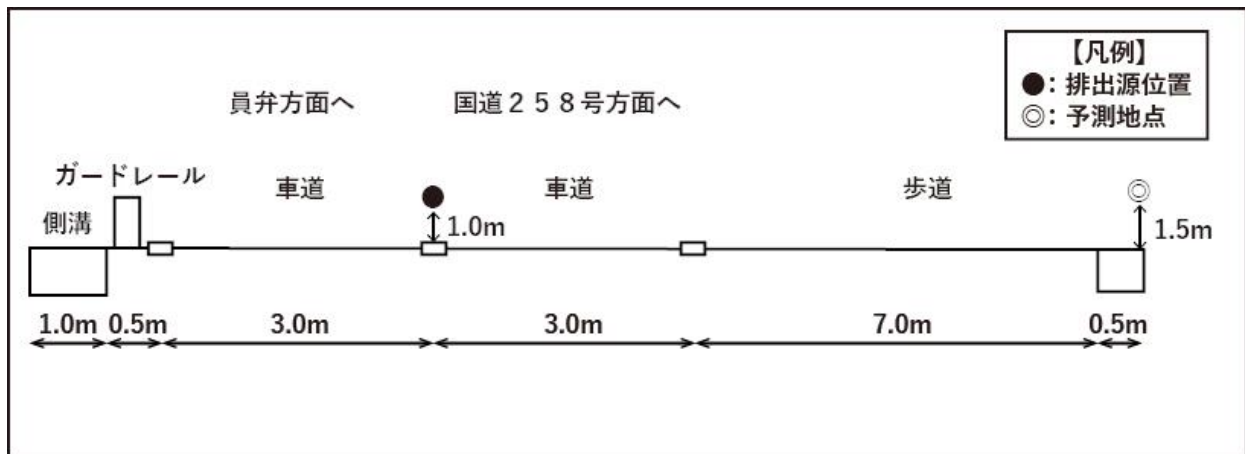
(1) 予測地点断面図 (RS-1)
